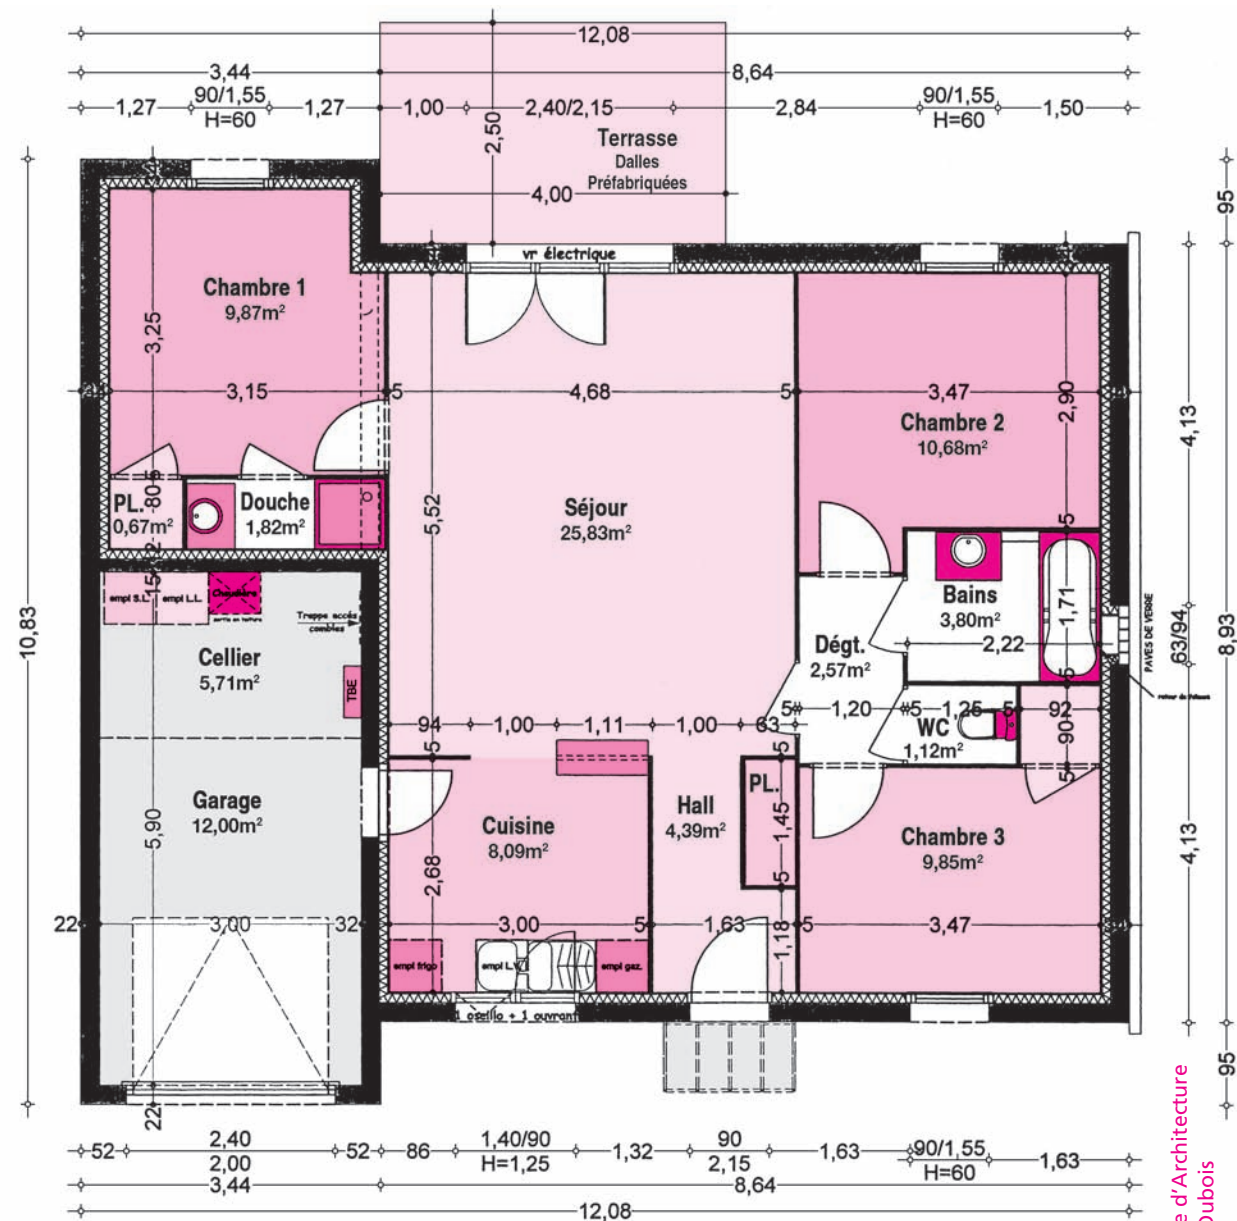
Maison de type IV en rez-de-chaussée et de surface habitable de 78,70 m²
